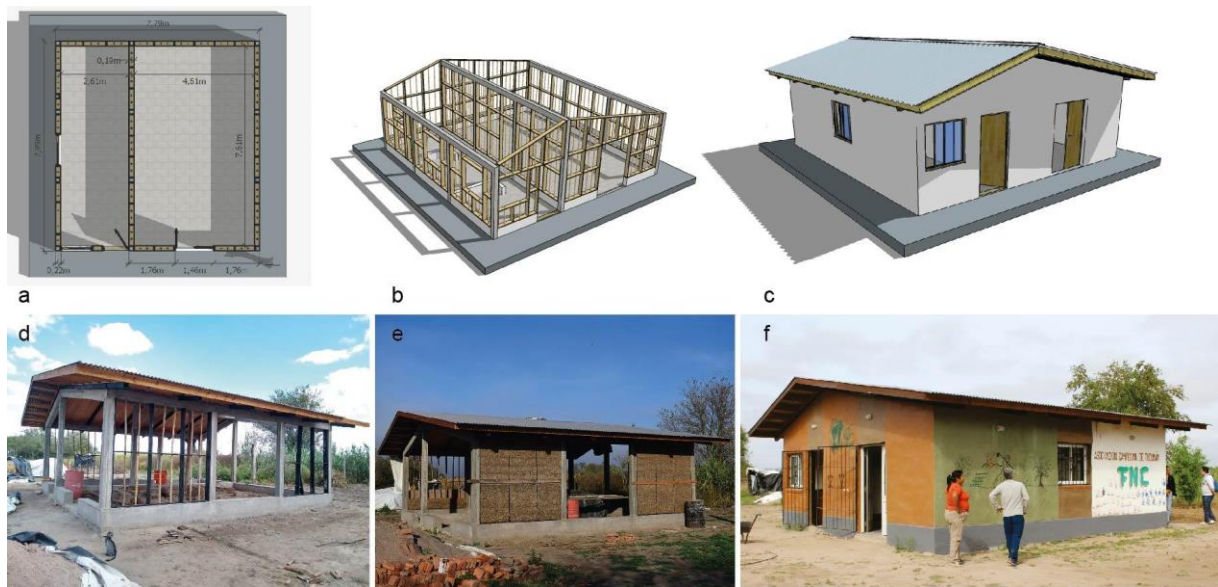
En la parte superior planta y vistas del proyecto. En la parte inferior imágenes del proceso constructivo.
